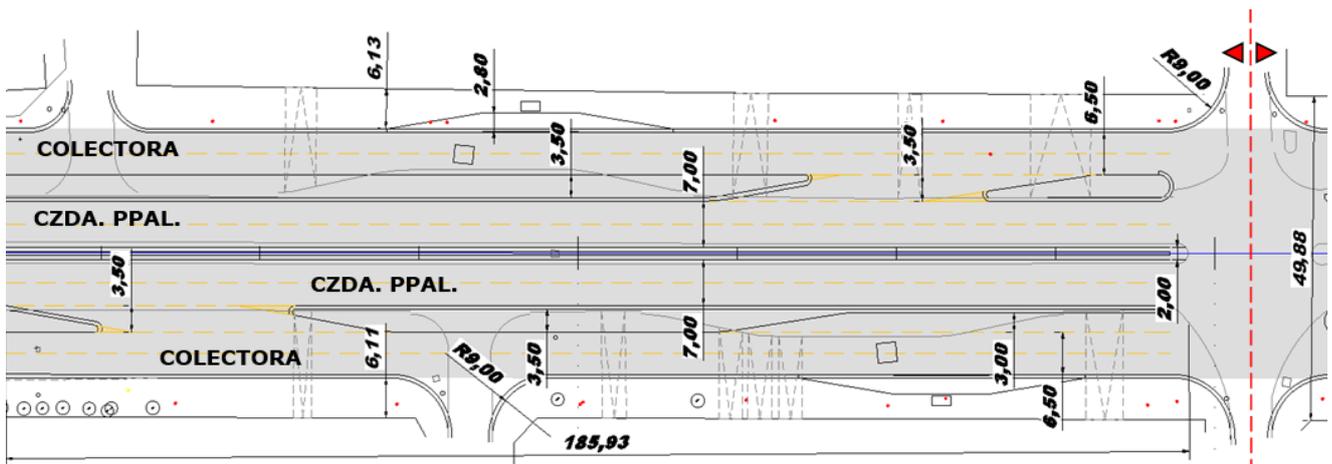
Imagen en planta media intersección (anchos de obra básica, radios de giro, etc.)
